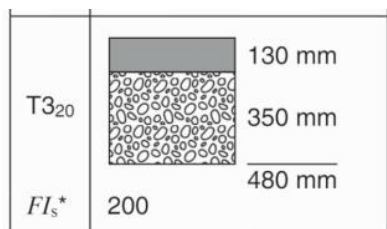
Structure de la chaussée existante de l'échantillon 1 [5]
